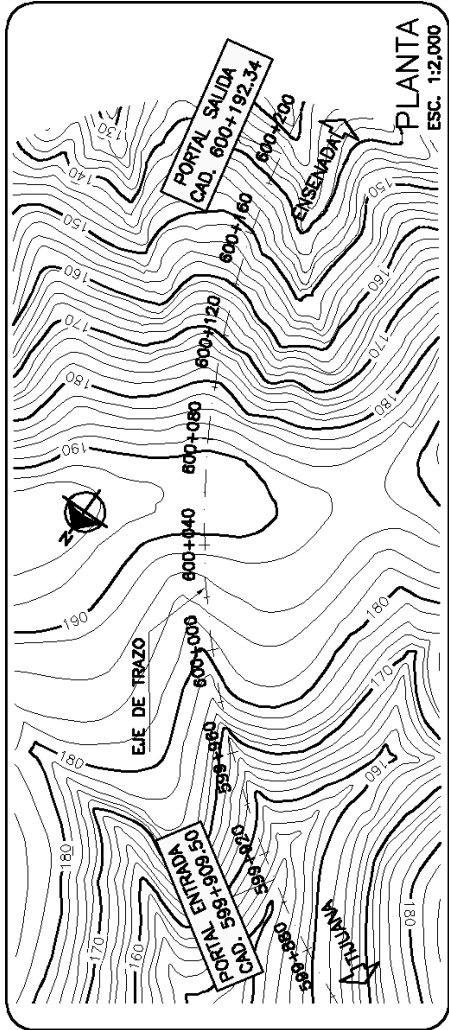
Planta topográfica y perfil del área contemplada para la excavación del Túnel Olivares.
